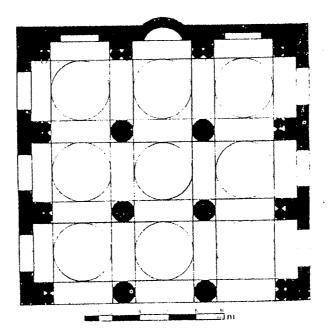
مسقط أفقي لمسجد بارسيما . (عن : Gabriel) .
